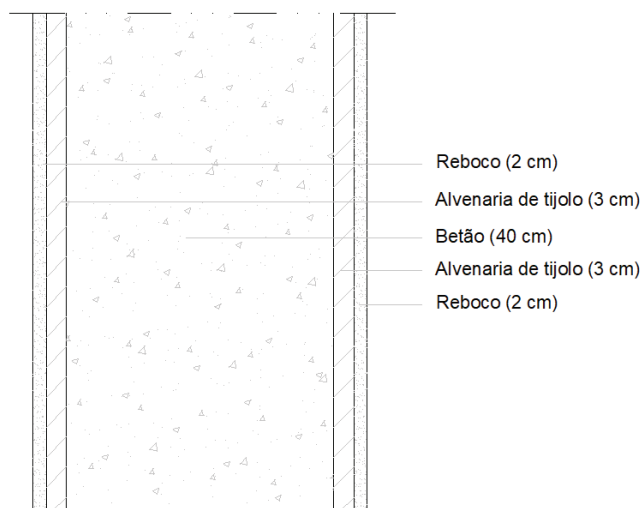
Pormenor construtivo da parede interior tipo XIII (*courette*)
